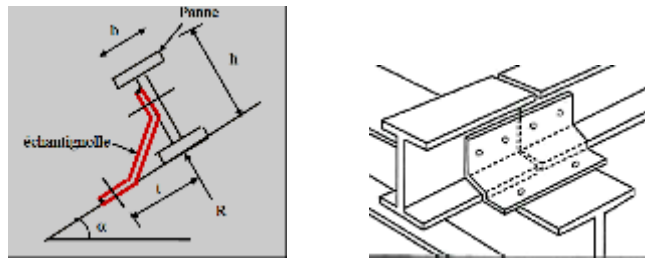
détails de disposition de l'échantignolle sur poutre traverse de portique
